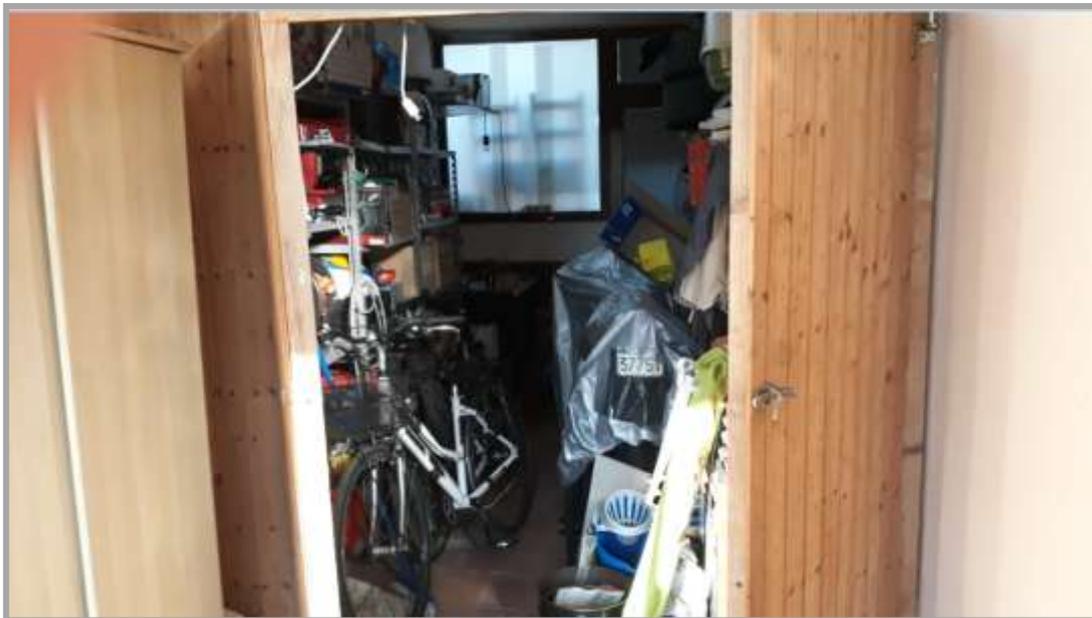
” – Vista della porzione di vano al piano terreno chiusa dalla struttura in legno
